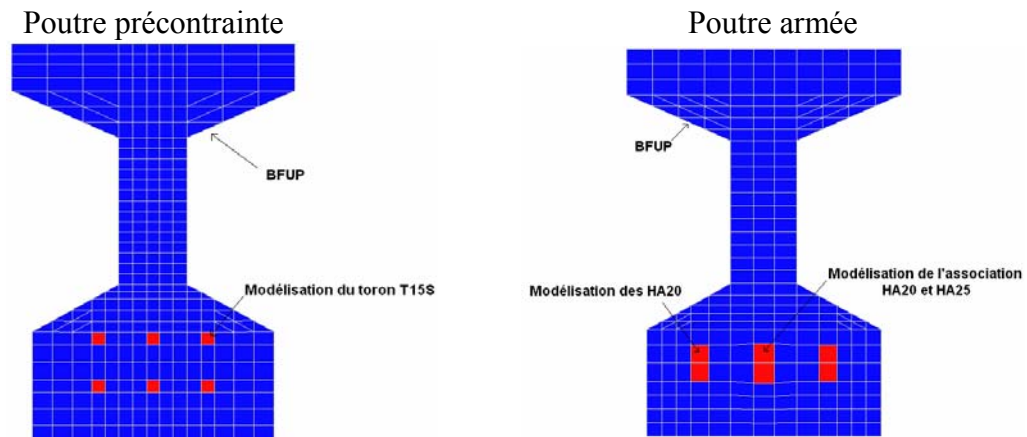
Section transversale des poutres modélisées [vue selon le plan (z,y)]
